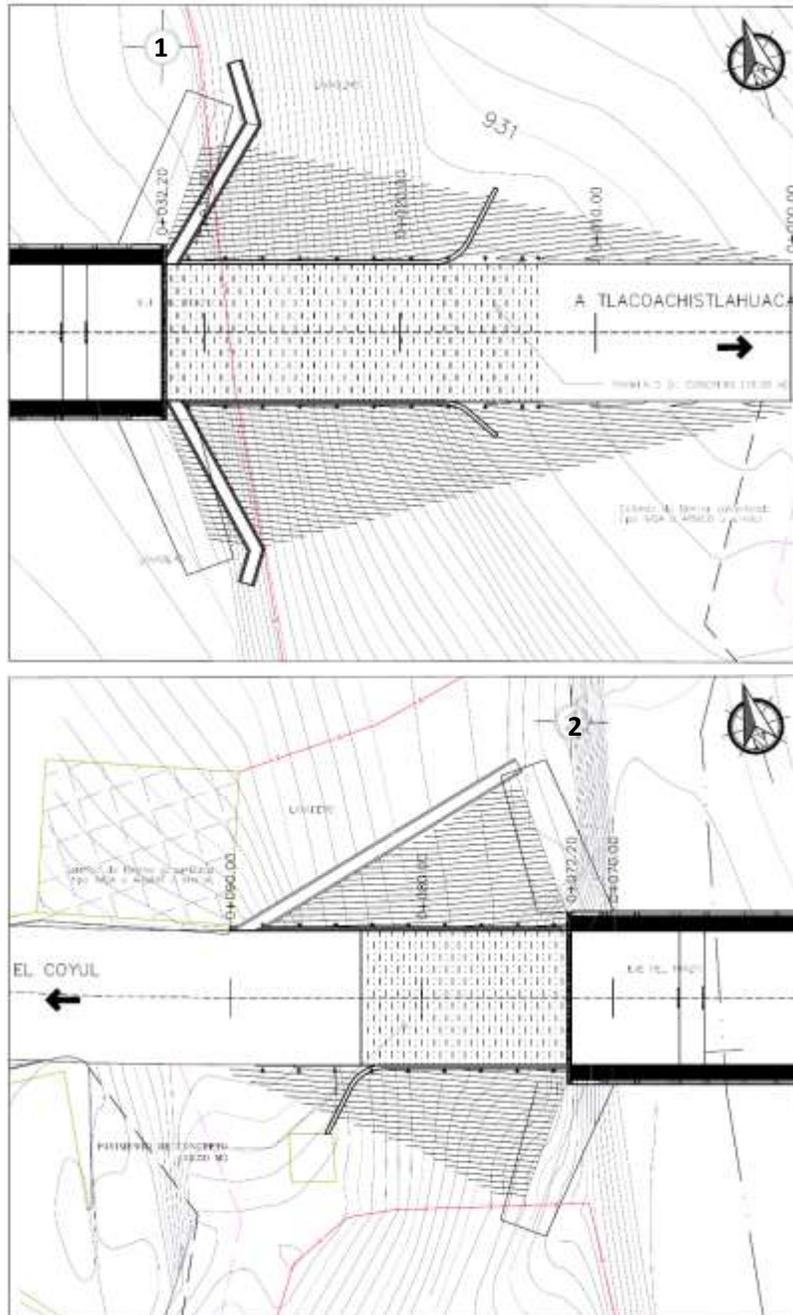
Planta de los accesos 1 y 2 del Puente Plan Buenavista
